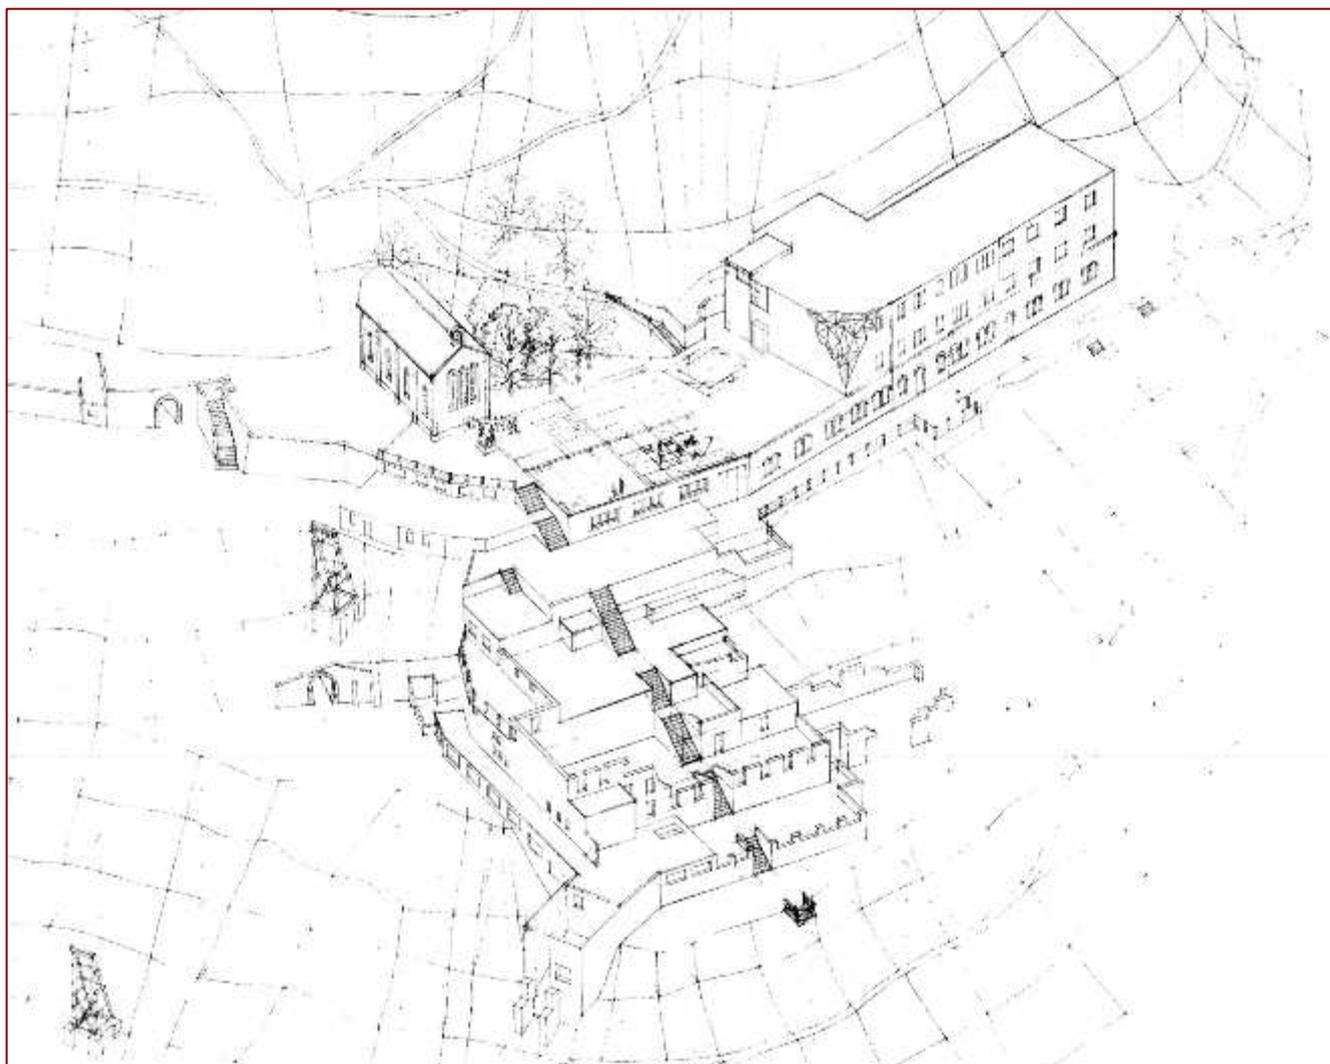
prospetto recupero complesso di colonna (tavola 10 allegata)
